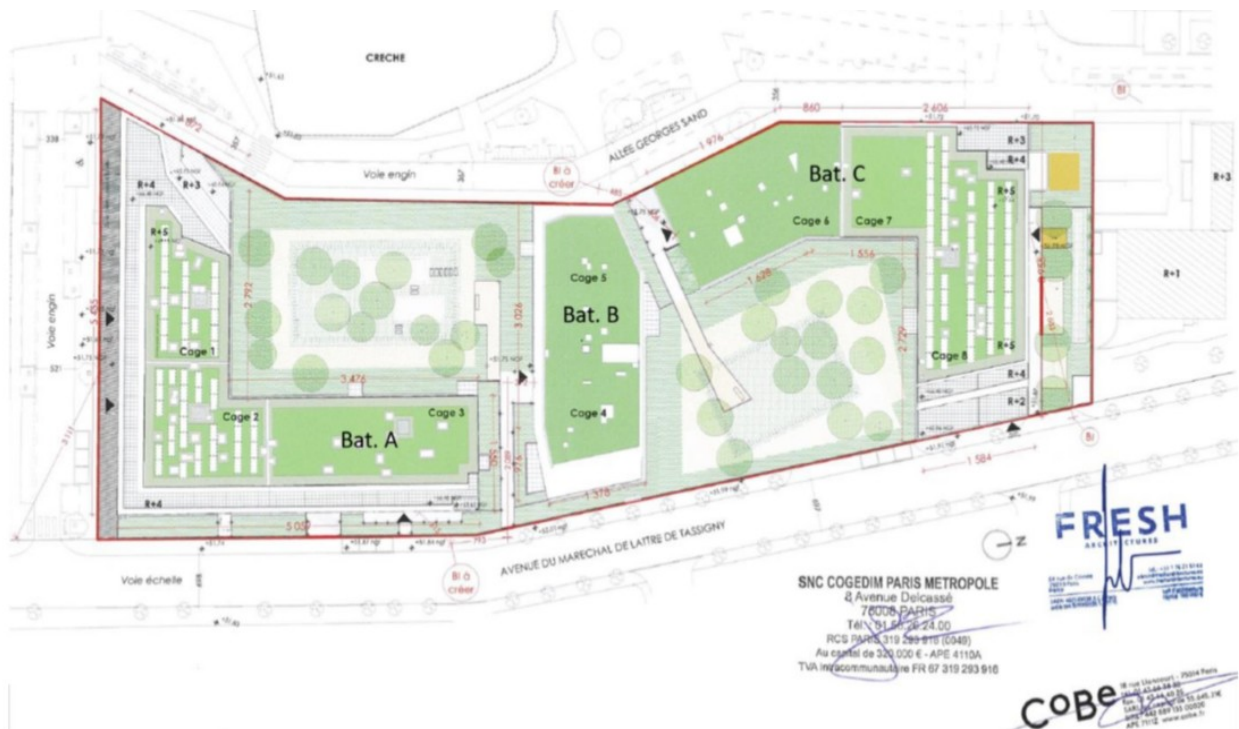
Plan masse - Source : Etude d'impact (figure 39 p.78) (nord à droite)
